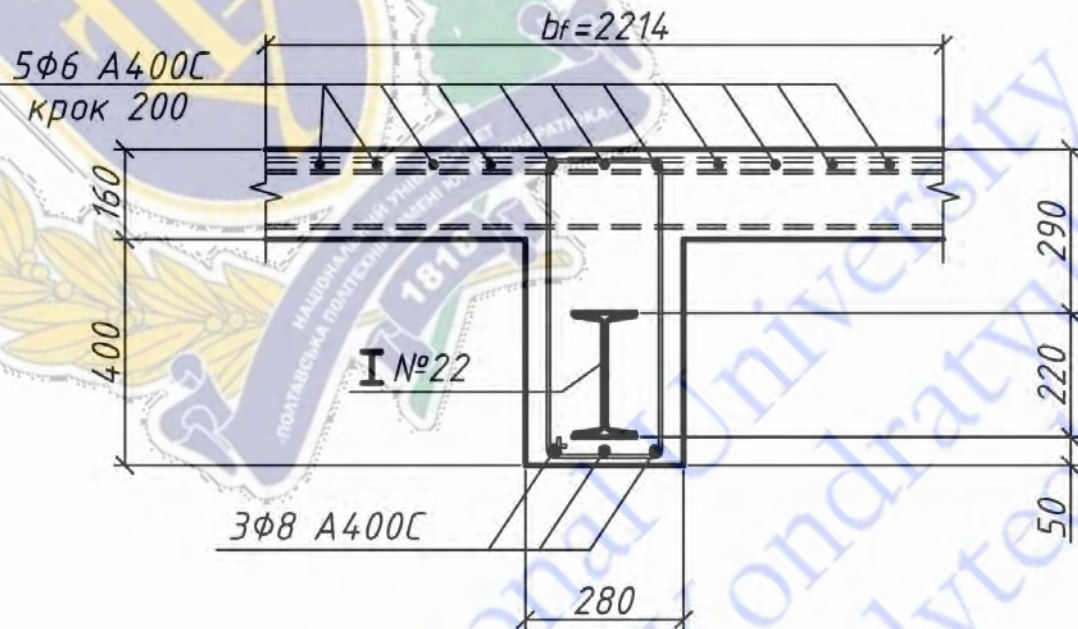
Конструктивне рішення армування перерізу сталезалізобетонного балкового елемента міжповерхового перекриття будівлі.
